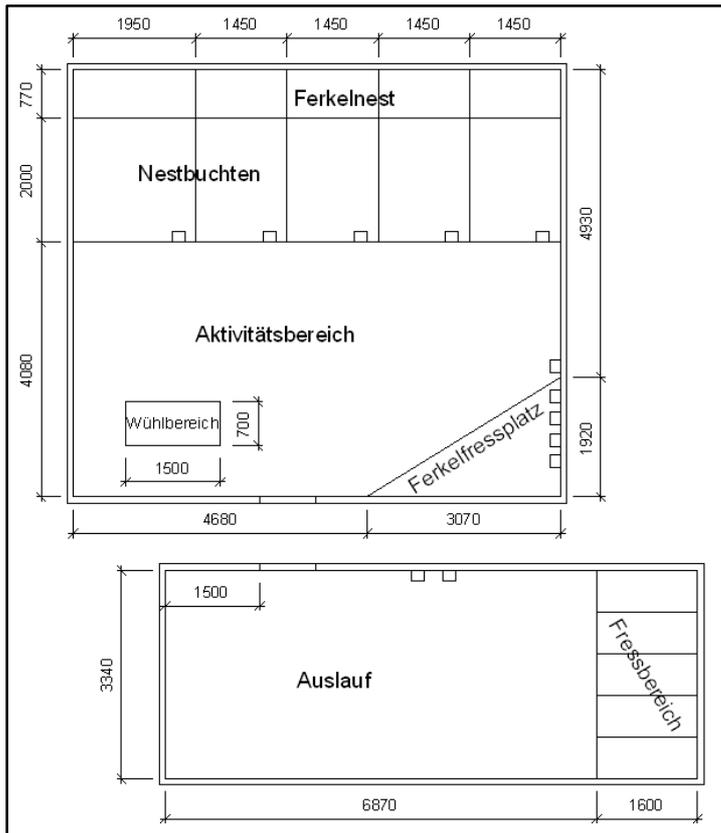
Grundriss für das Haltungssystem Gruppenabferkelung
